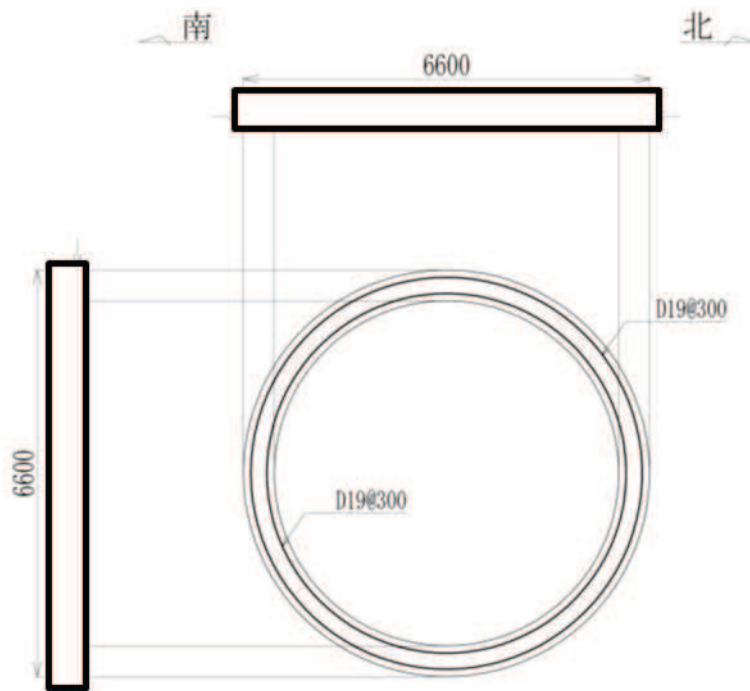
排気筒連絡ダクト概略配筋図 (B-B 断面, 岩盤部)
